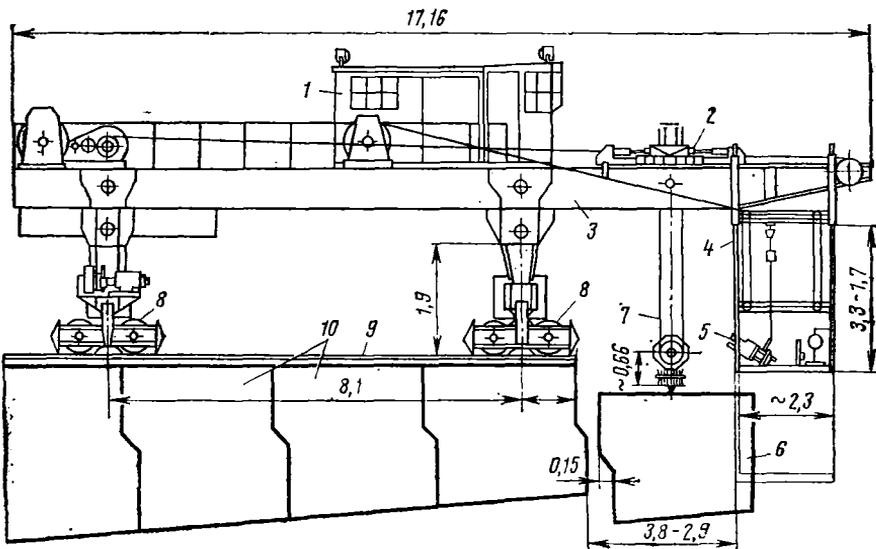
Схема монтажа краном-агрегатом СПК-65:
